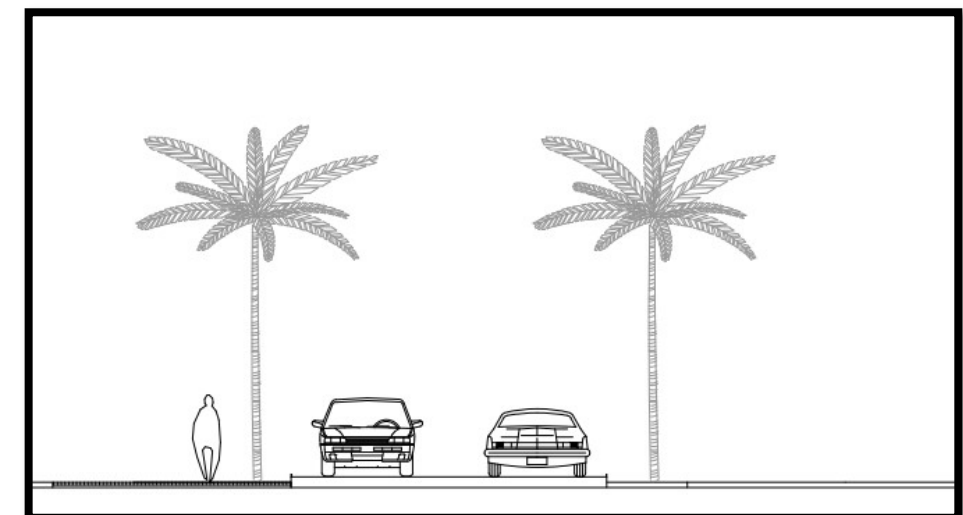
Sección transversal tramo 3. Fuente: Elaboración propia
